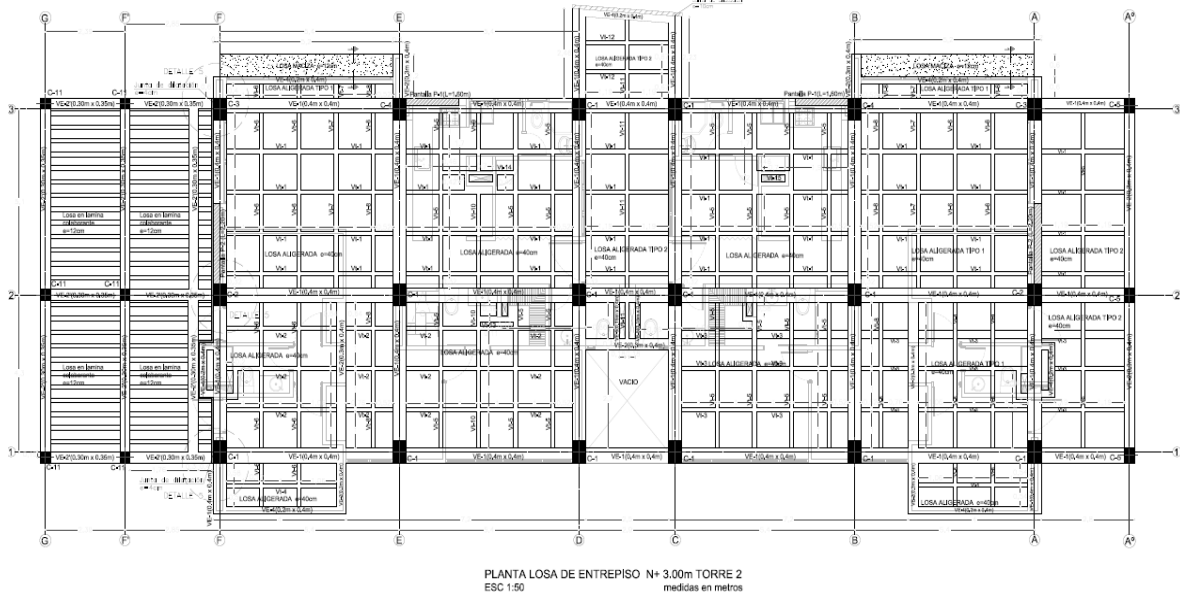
Planta de Entrepiso Bloque A Torre Típica.
